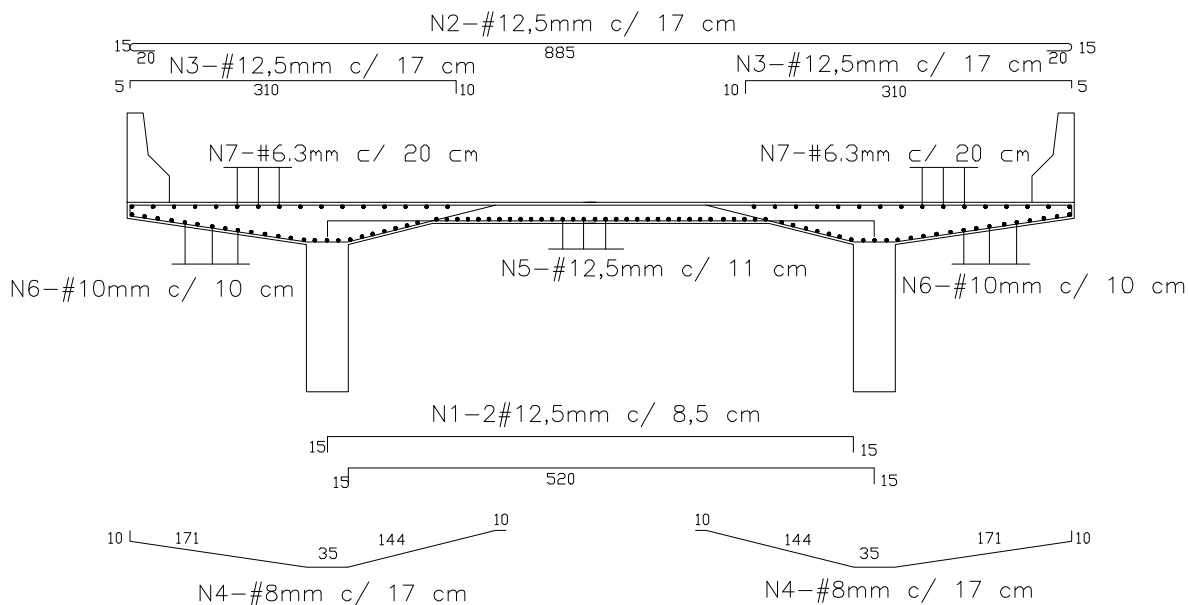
Detalhe da armadura de flexão da laje do tabuleiro.
